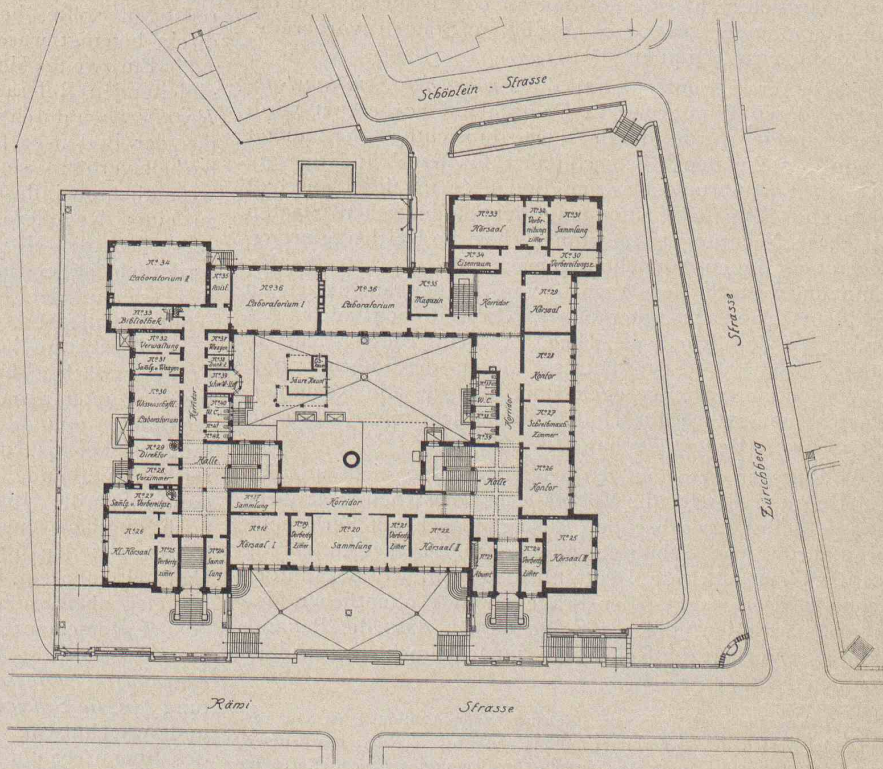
Lageplan mit Erdgeschoss-Grundriss. — Masstab 1:1000.
